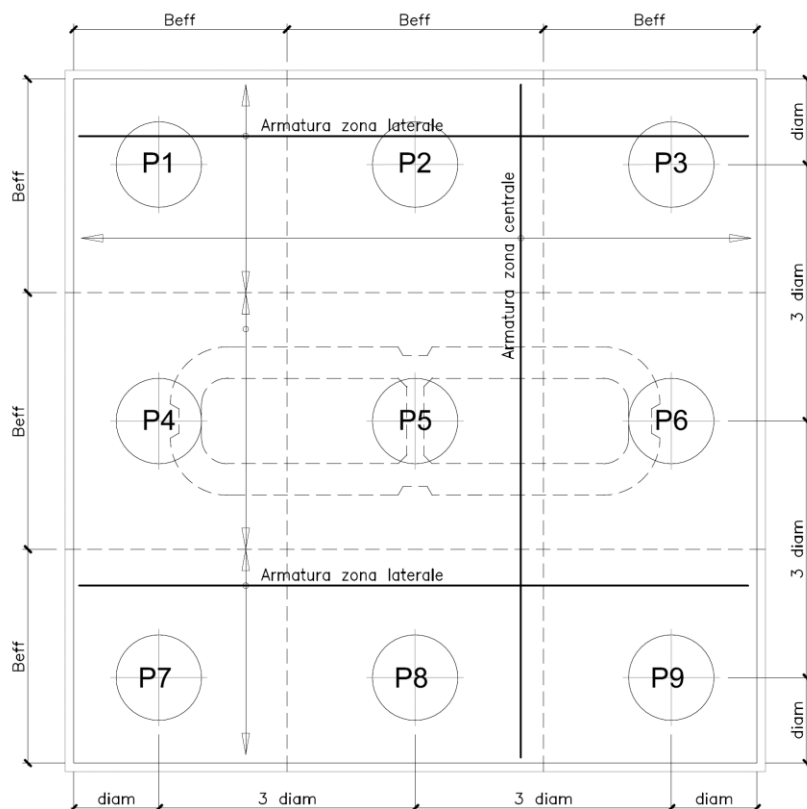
Plinto di fondazione – Armatura longitudinale inferiore e superiore
